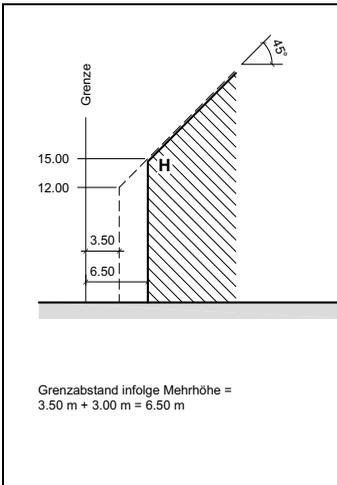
Grenzabstand eines komplizierten Baukörpers
